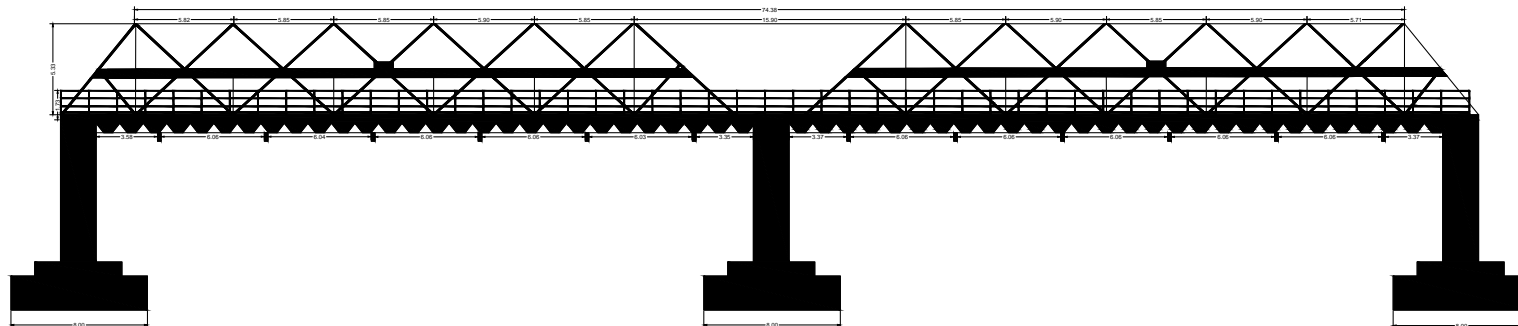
Plano de alzados este puente Centenario carrera 5 Neiva-Huila
